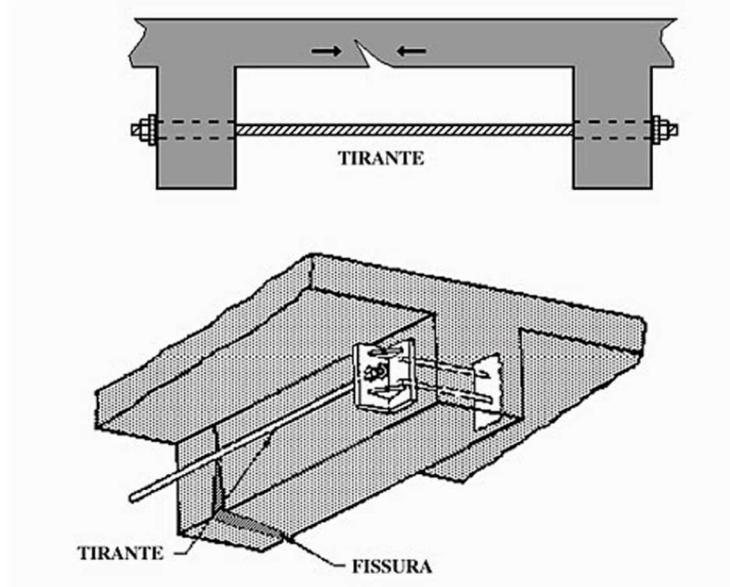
Costura de fenda em vigas (RIPPER, 1998)
